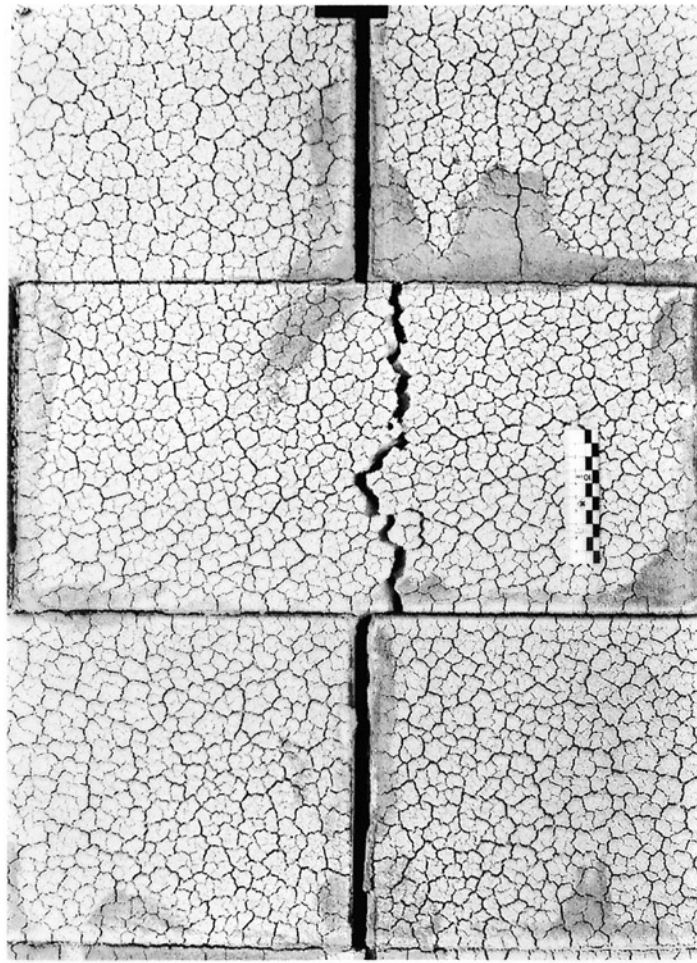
Porenbeton-Oberfläche nach > 90 min Brandbeanspruchung nach DIN 4102-2 (ETK)
